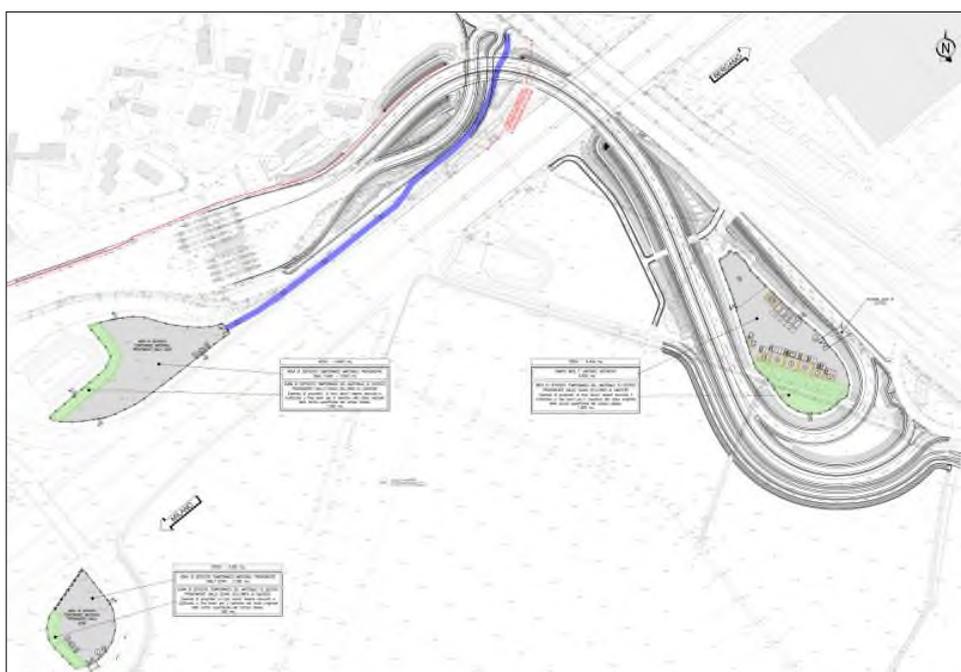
Quadro di insieme della cantierizzazione (stralcio da CAP201)
